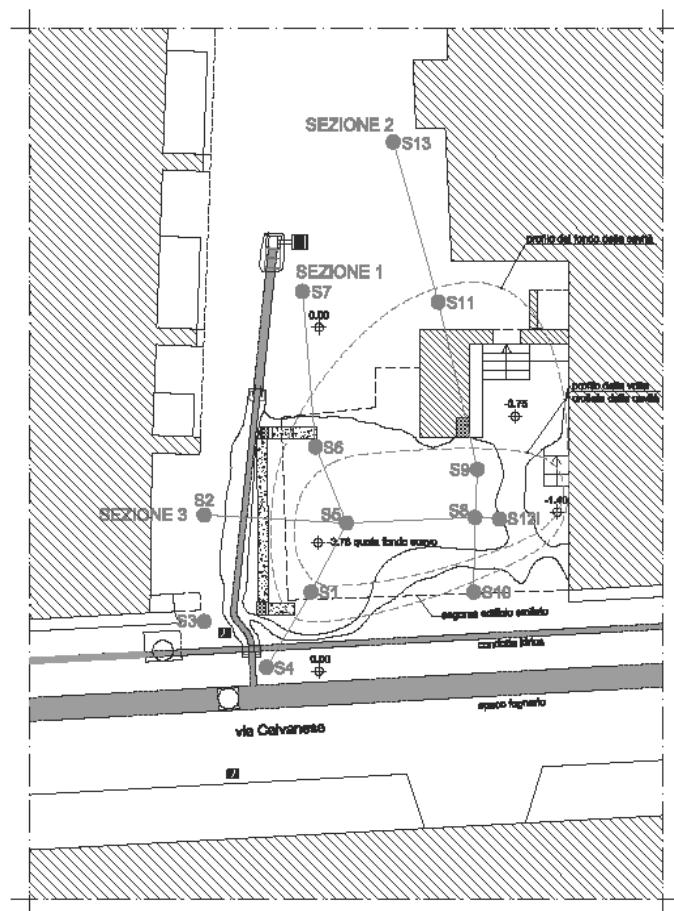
Planimetria schematica di luoghi e posizione dei sondaggi.
